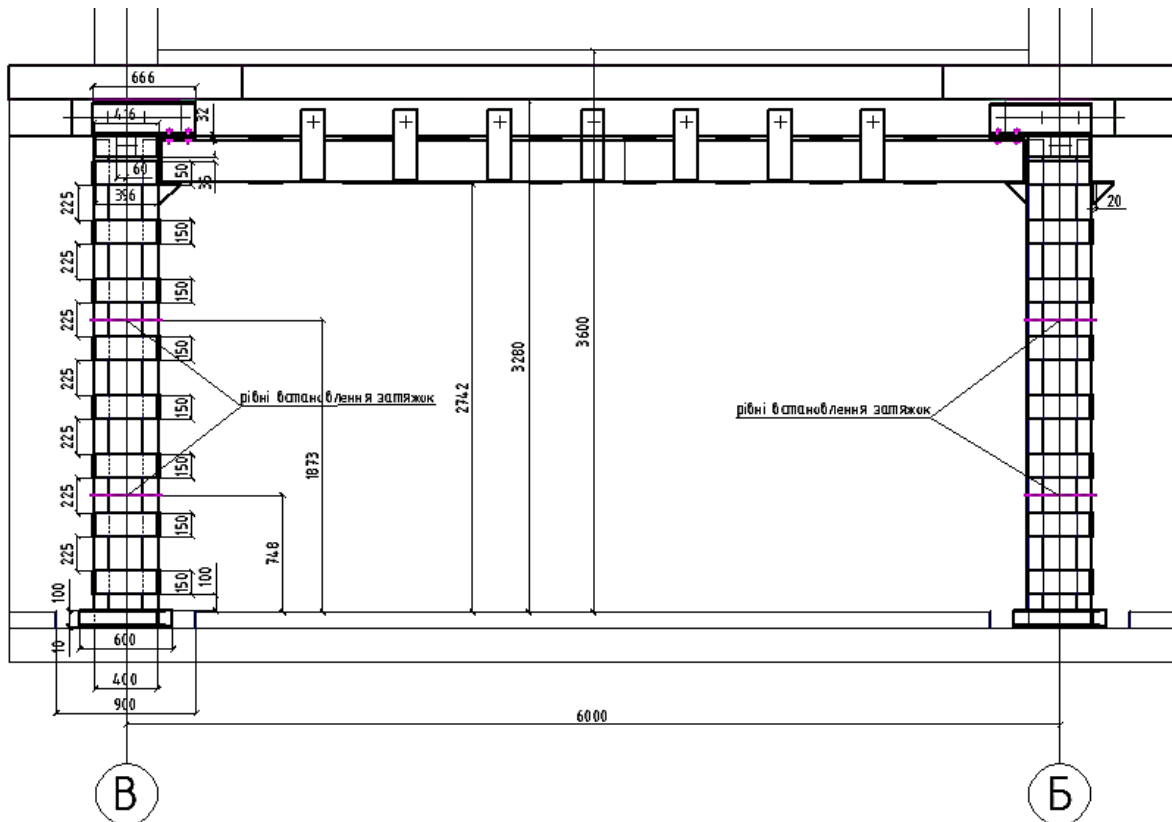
Конструктивне рішення по підсиленню рами каркасу будівлі
